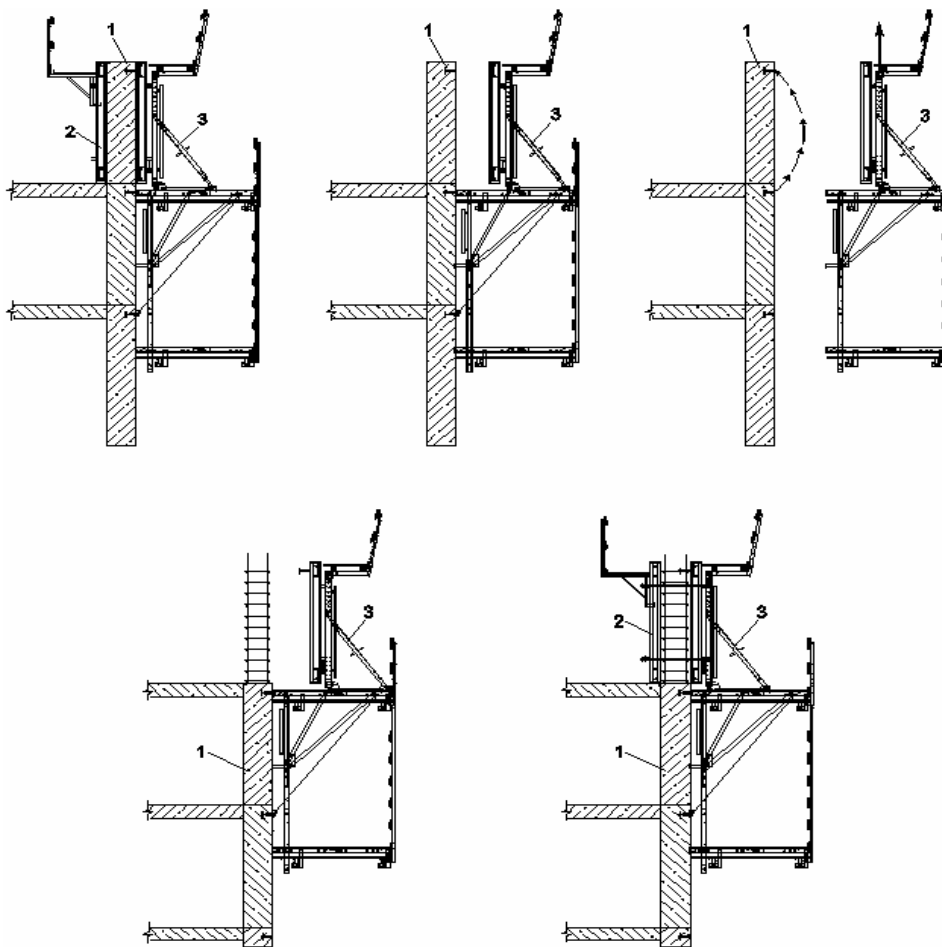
Схема перемещения подъемно-переставной опалубки на следующую захватку:
